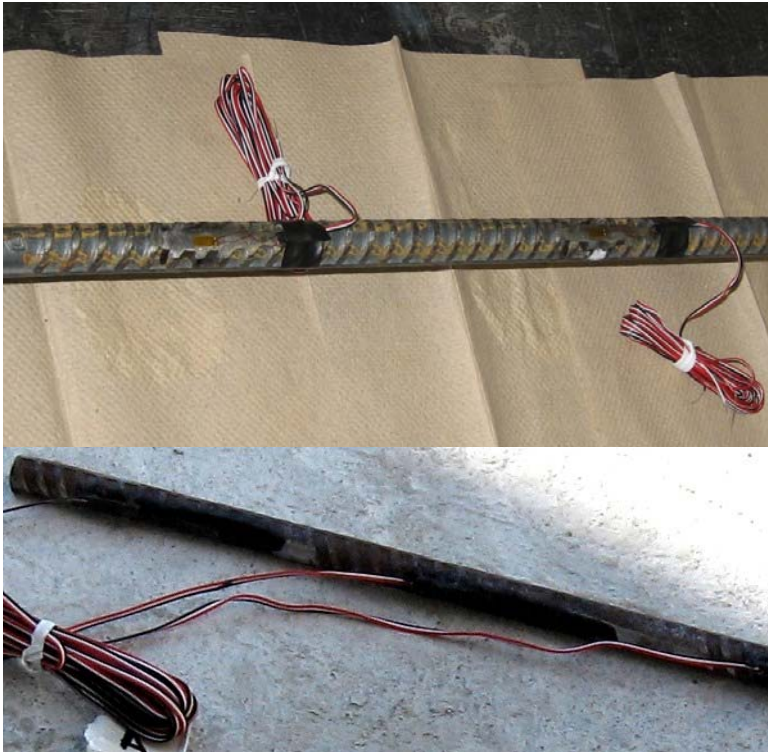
Jauges de déformation sur une barre de renforcement en cisaillement
